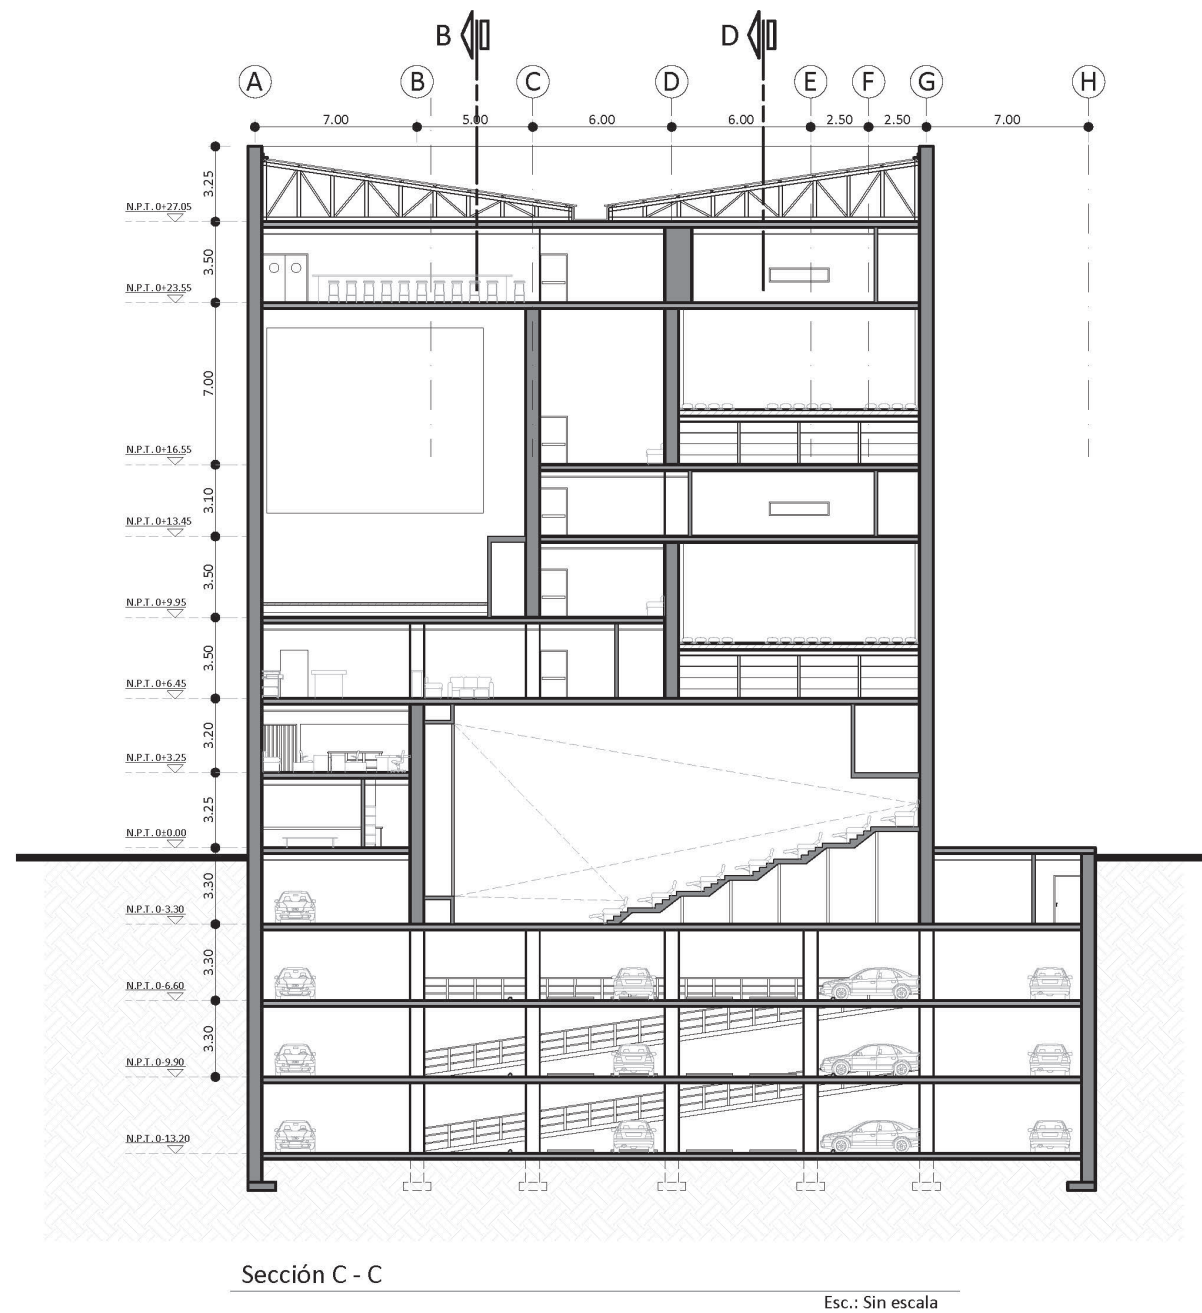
Sección arquitectónica C - C. Fuente: Propia.
